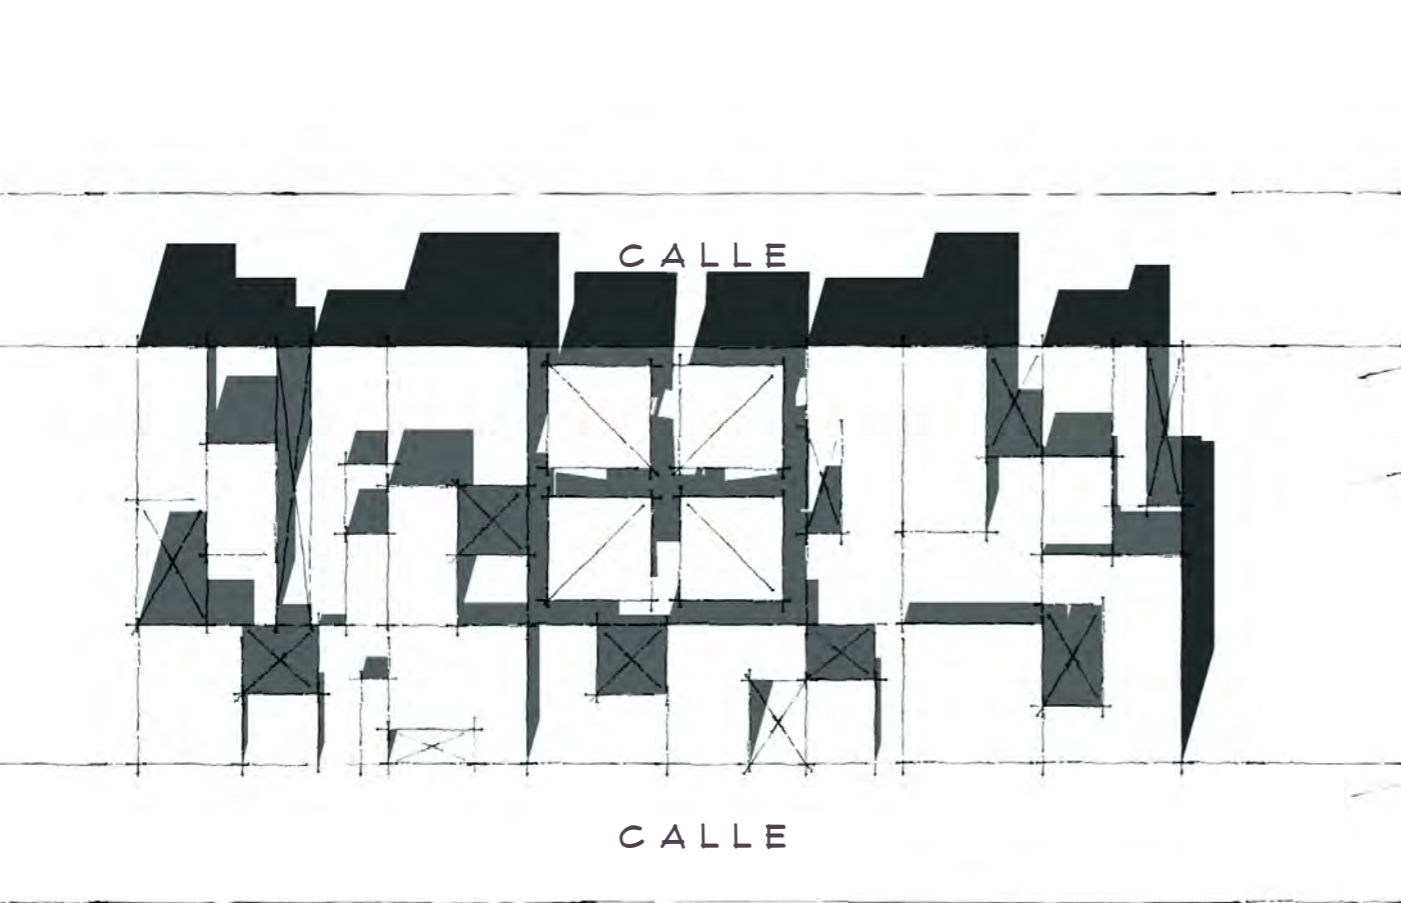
Croquis de emplazamiento de proyecto, ubicado en zonas construidas, elaborado por César Hernández, 2018.
